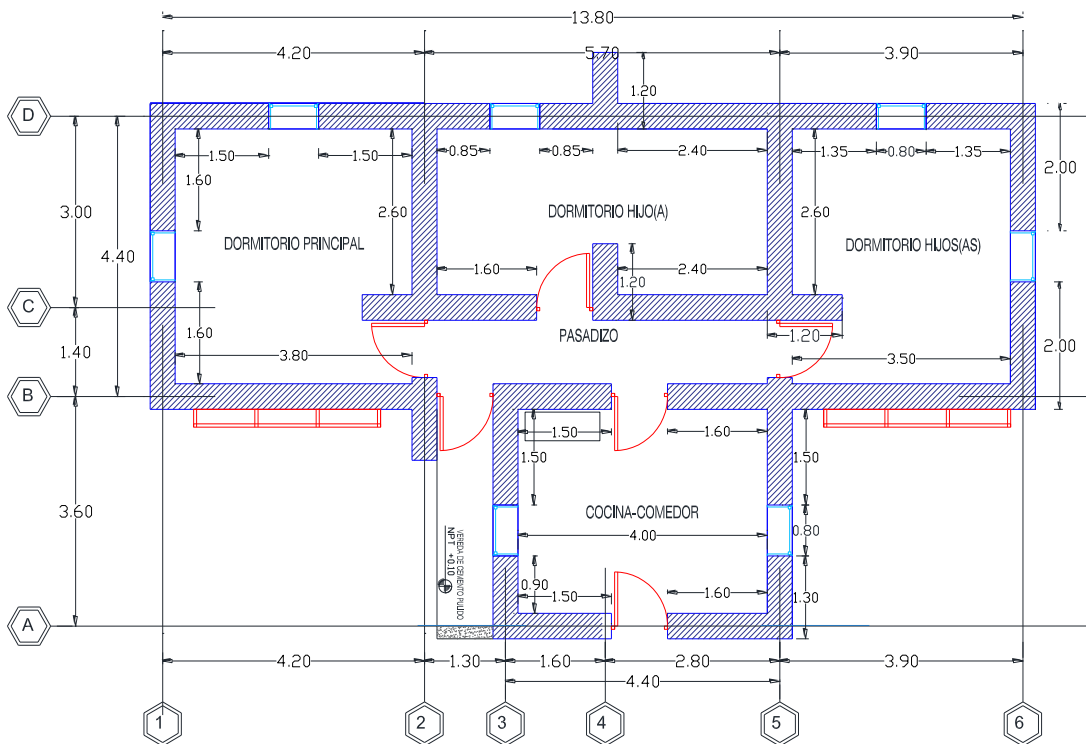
Plano de planta de propuesta de vivienda para cinco personas
